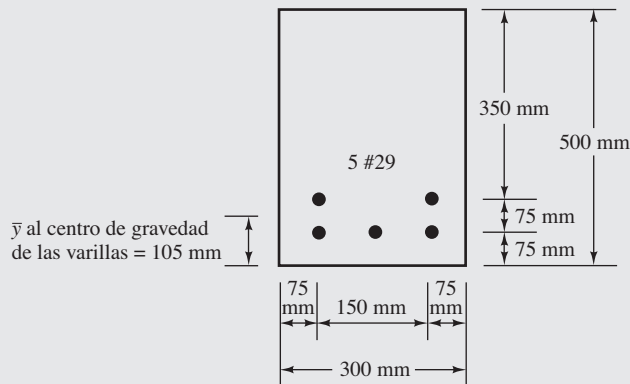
Sección transversal de la viga del Ejemplo 6.4.
